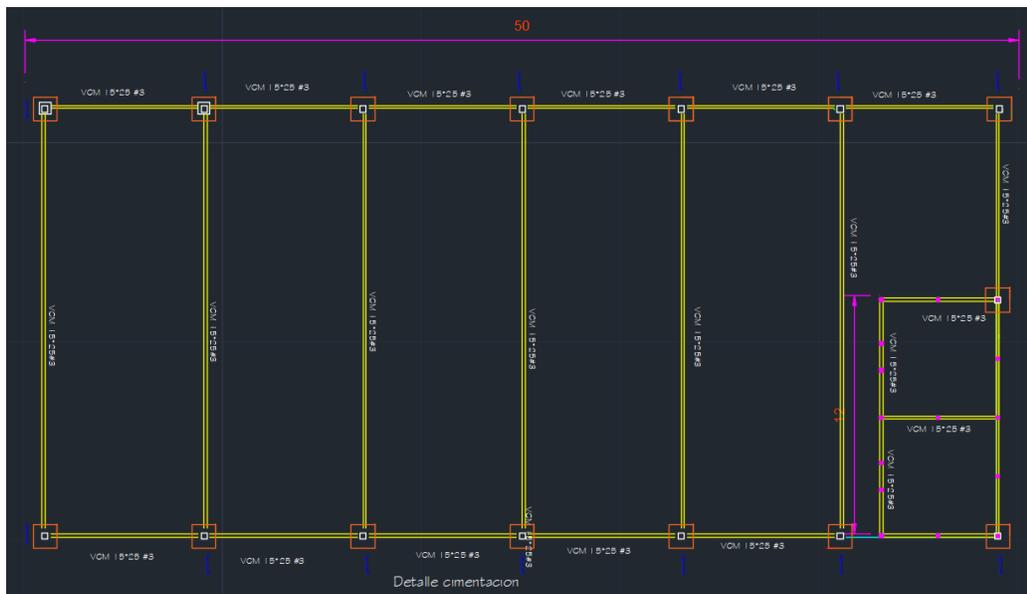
Plano arquitectónico Fuente: Elaboración propia
